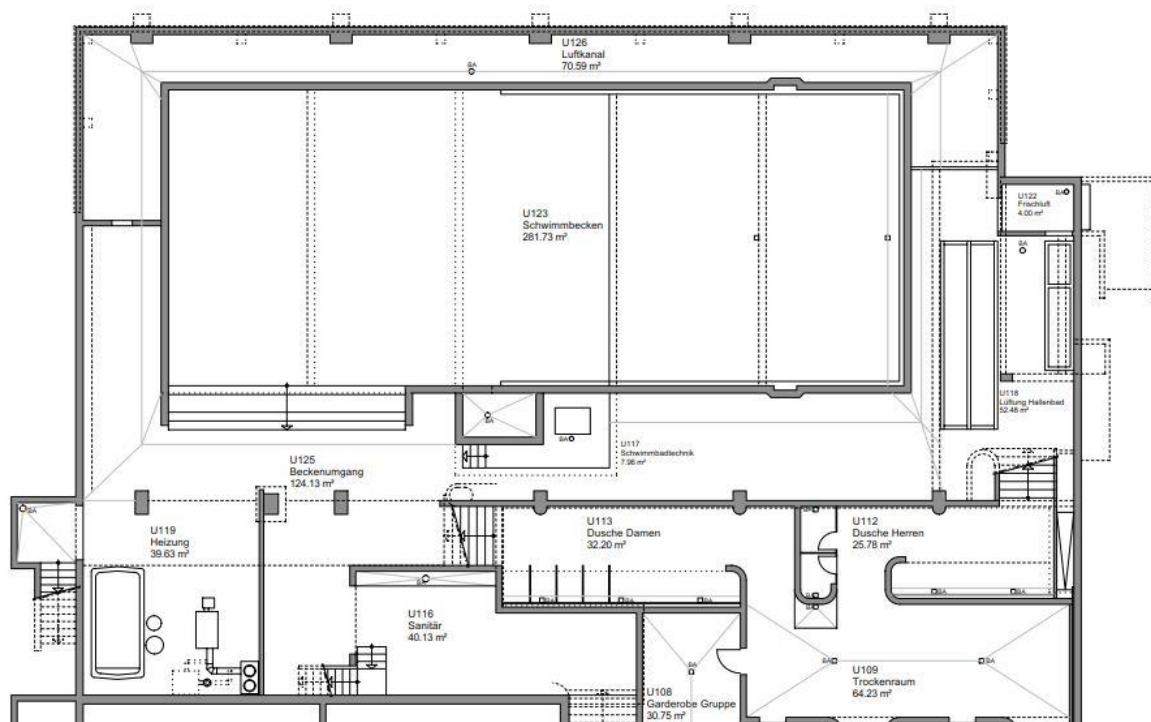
2. Untergeschoss mit Beckenumgang und Technikräume
